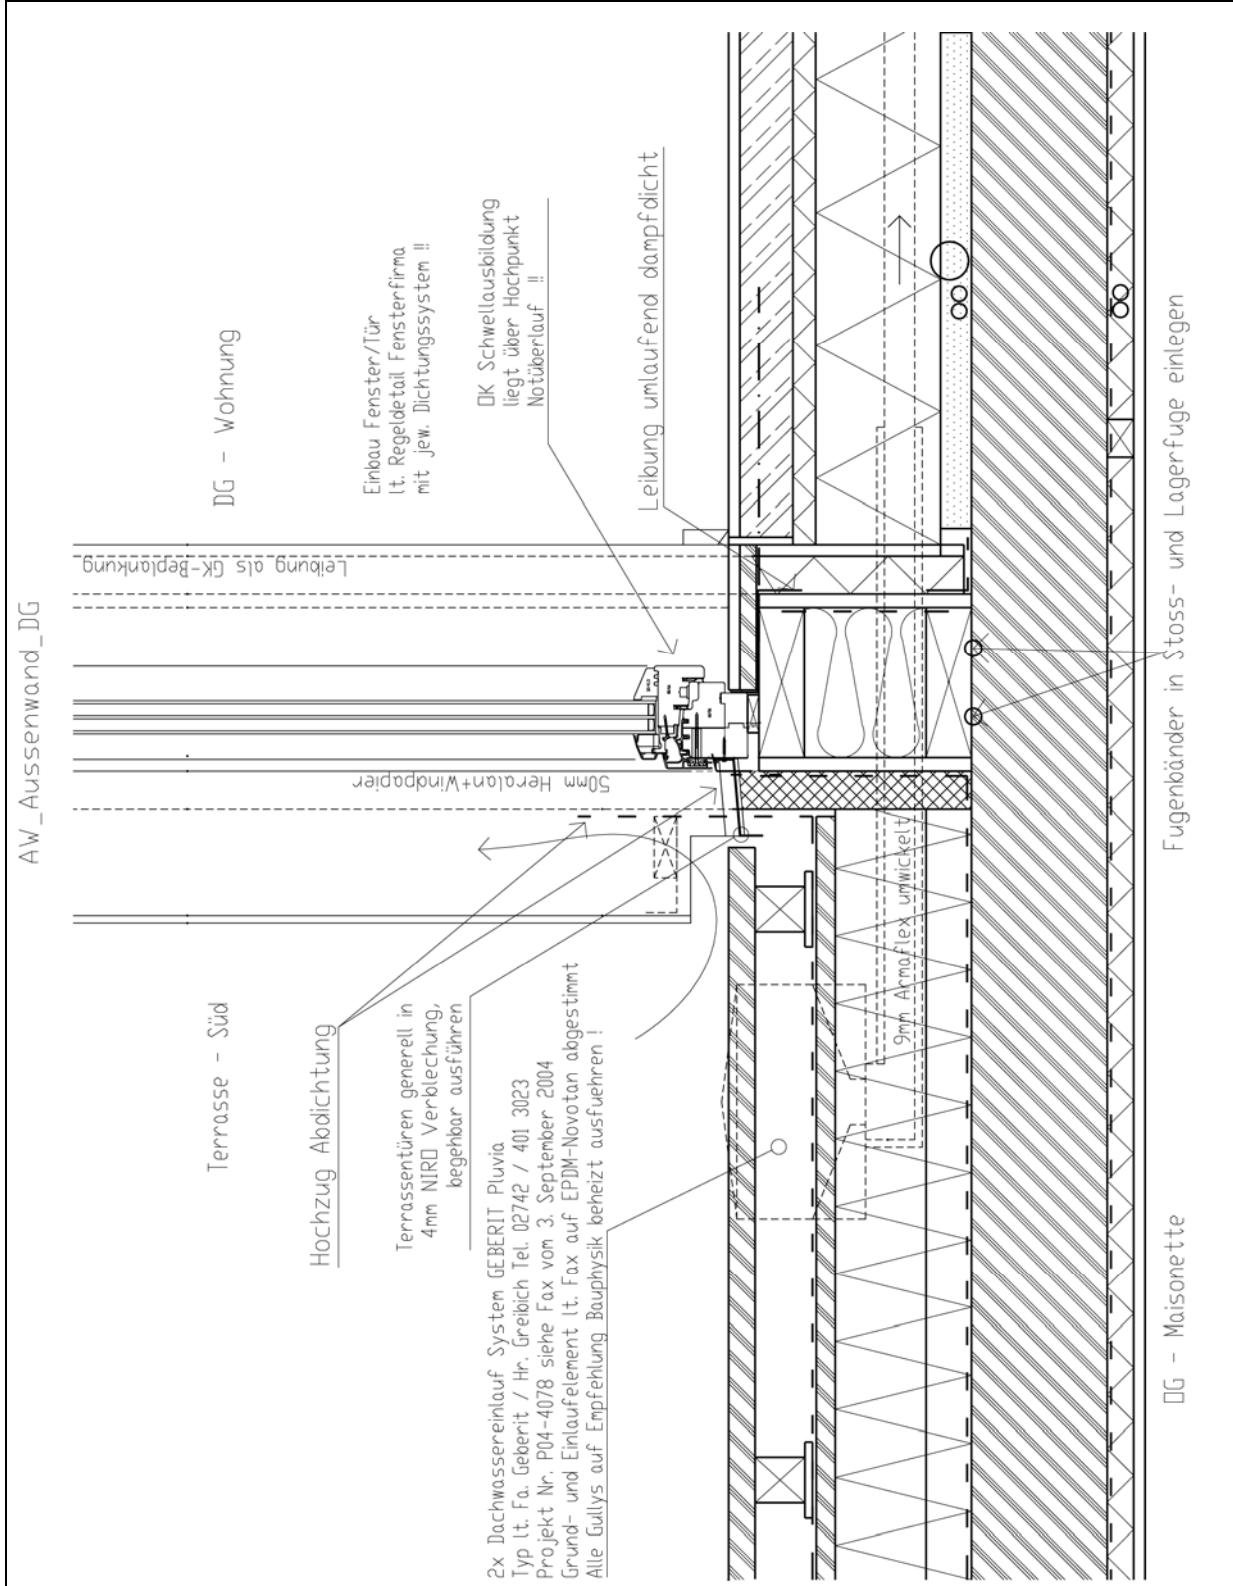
Baudetail Projekt "Smart Housing" Außenwand/Terrasse Det.02
